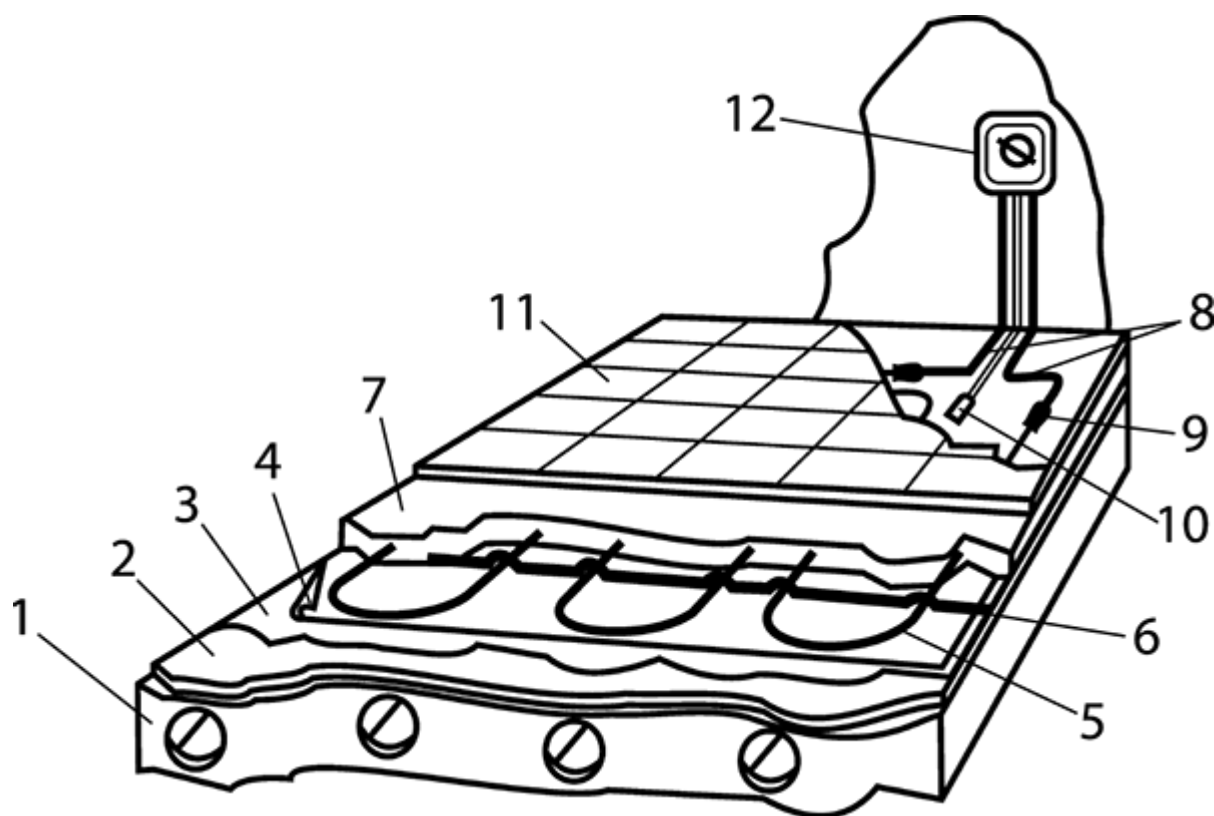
Схема устройства теплого пола: 1 – перекрытие; 2 – теплоизоляция; 3 – черновая стяжка (1 см); 4 – фольга; 5 – нагревательный элемент; 6 – монтажная лента; 7 – цементно-песчаная стяжка (2–5 см); 8 – холодные концы подключения к сети; 9 – муфта; 10 – датчик температуры; 11 – керамическая плитка; 12 – терморегулятор
